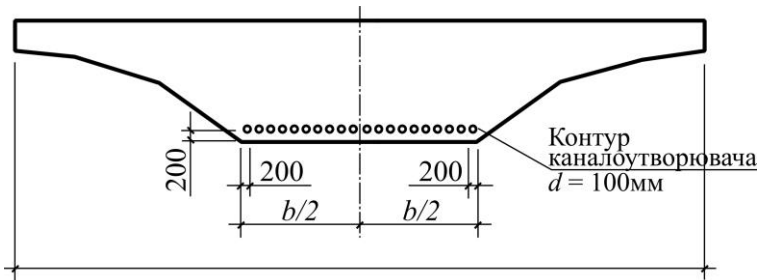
Розташування попередньо-напруженої арматури в середині прогону
